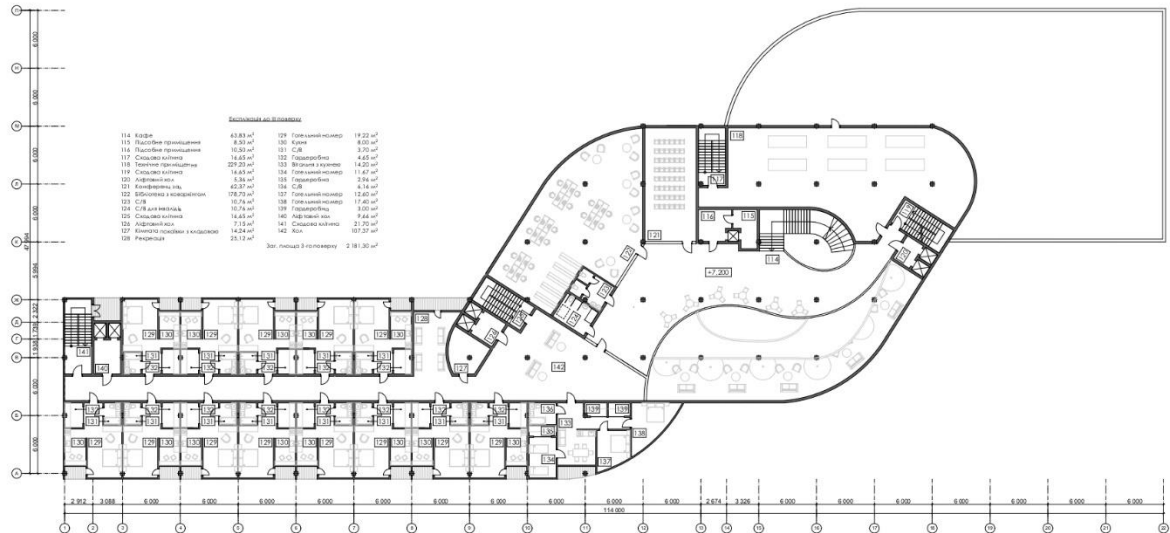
Планування 3-го поверху на відмітці +7.200
